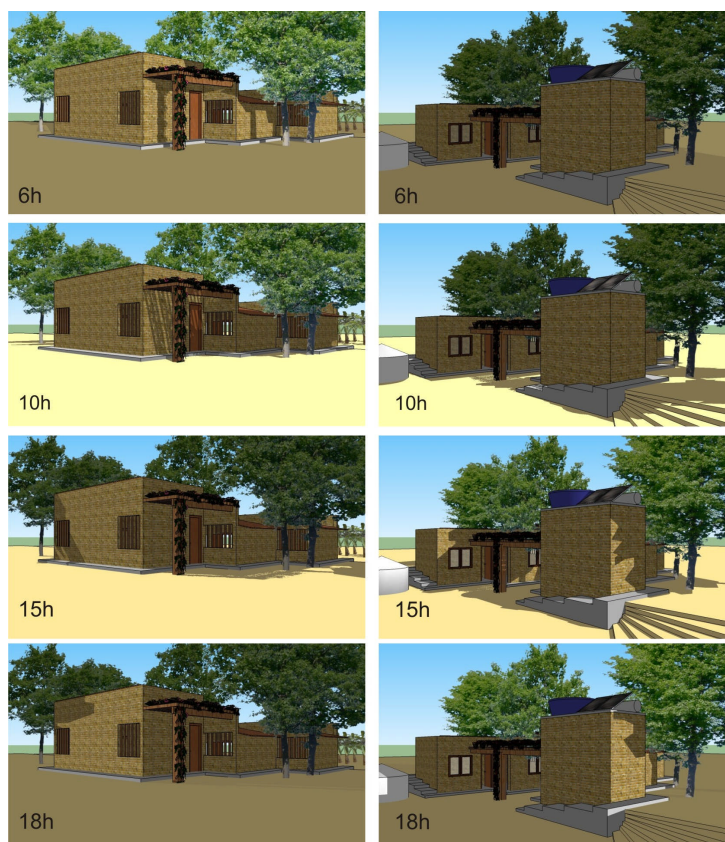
B – Condições de insolação e sombreamento de aberturas e fachadas da edificação em 21 de junho.
